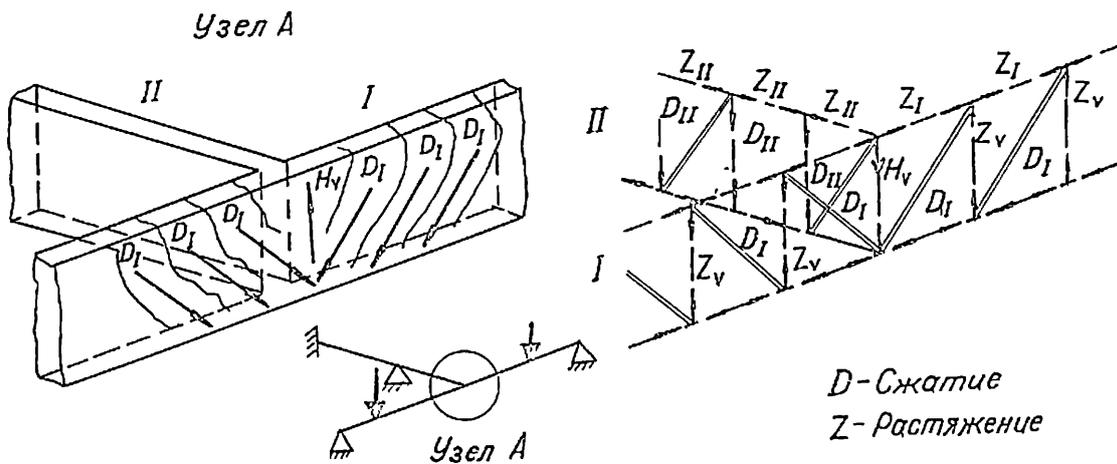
2. По аналогии с фермой непрямо опертая в точке "А" балка I должна быть присоединена к балке II через арматуру-подвеску, воспринимающую силу H_v
